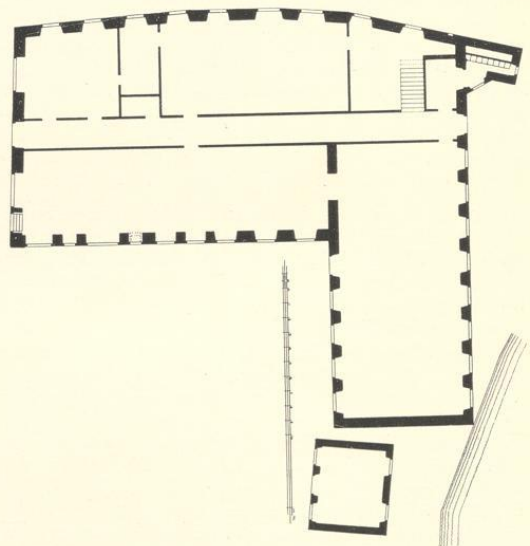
Grundriß des Erdgeschosses des Klosters Rosenthal im Jahre 1816; Maßstab 1:400; Pause
